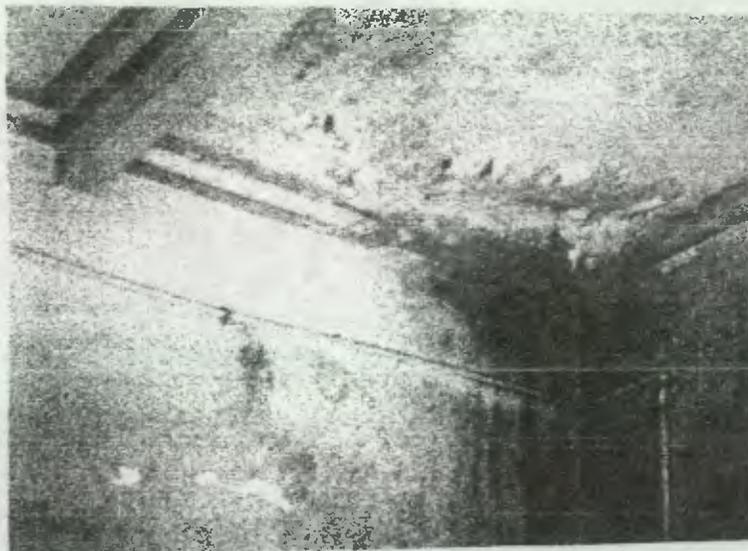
Detalle de filtración por bajada de agua pluvial, humedad. También detalle de viga.
